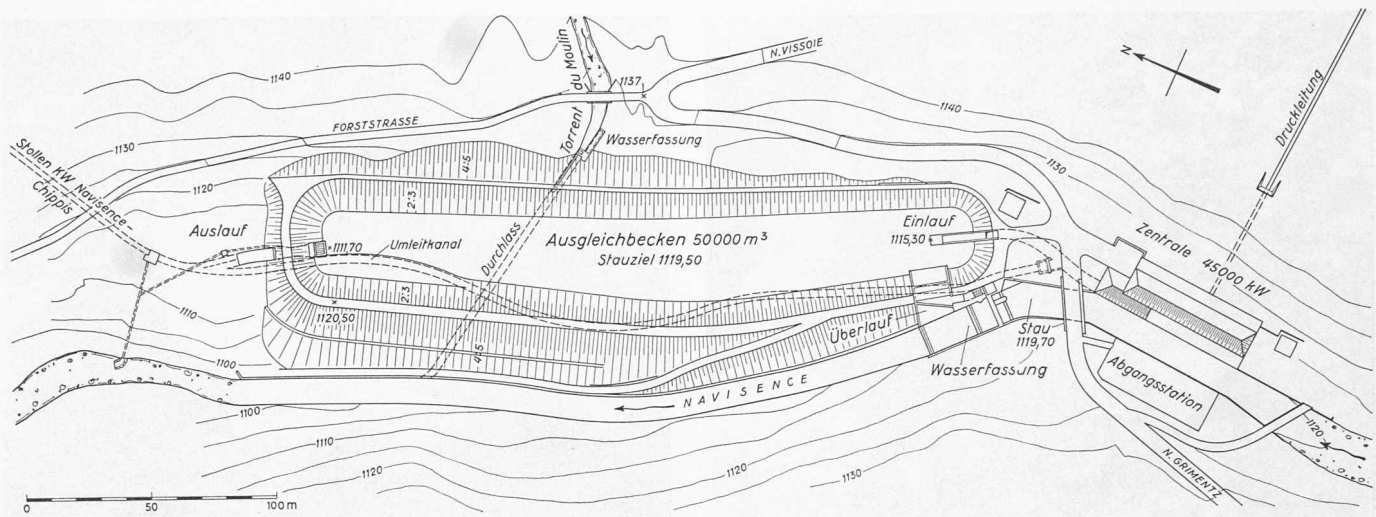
Ausgleichsbecken Vissoie der Kraftwerke Gougra AG., Lageplan 1:3000
